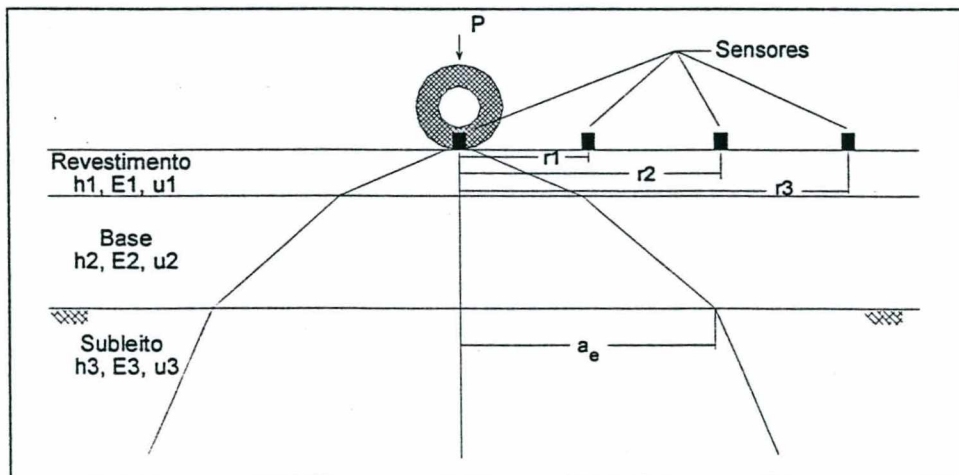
Estrutura esquemática de pavimento para retroanálise.
